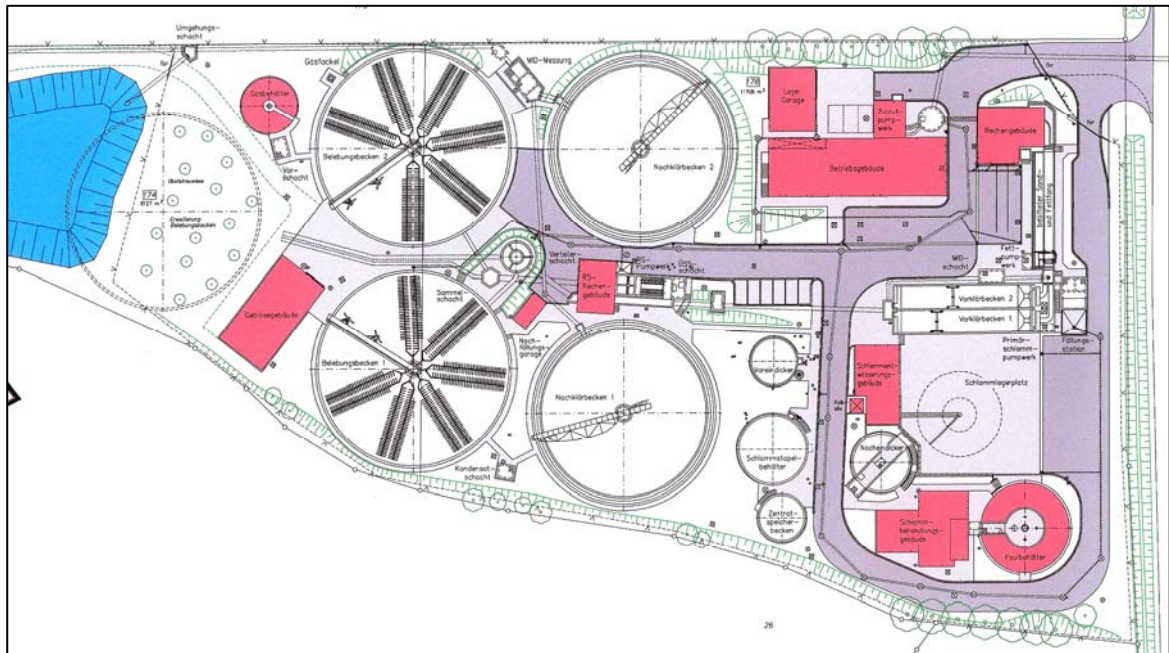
Lageplan Kläranlage Verl-West (rot – Ausbau 2004)
